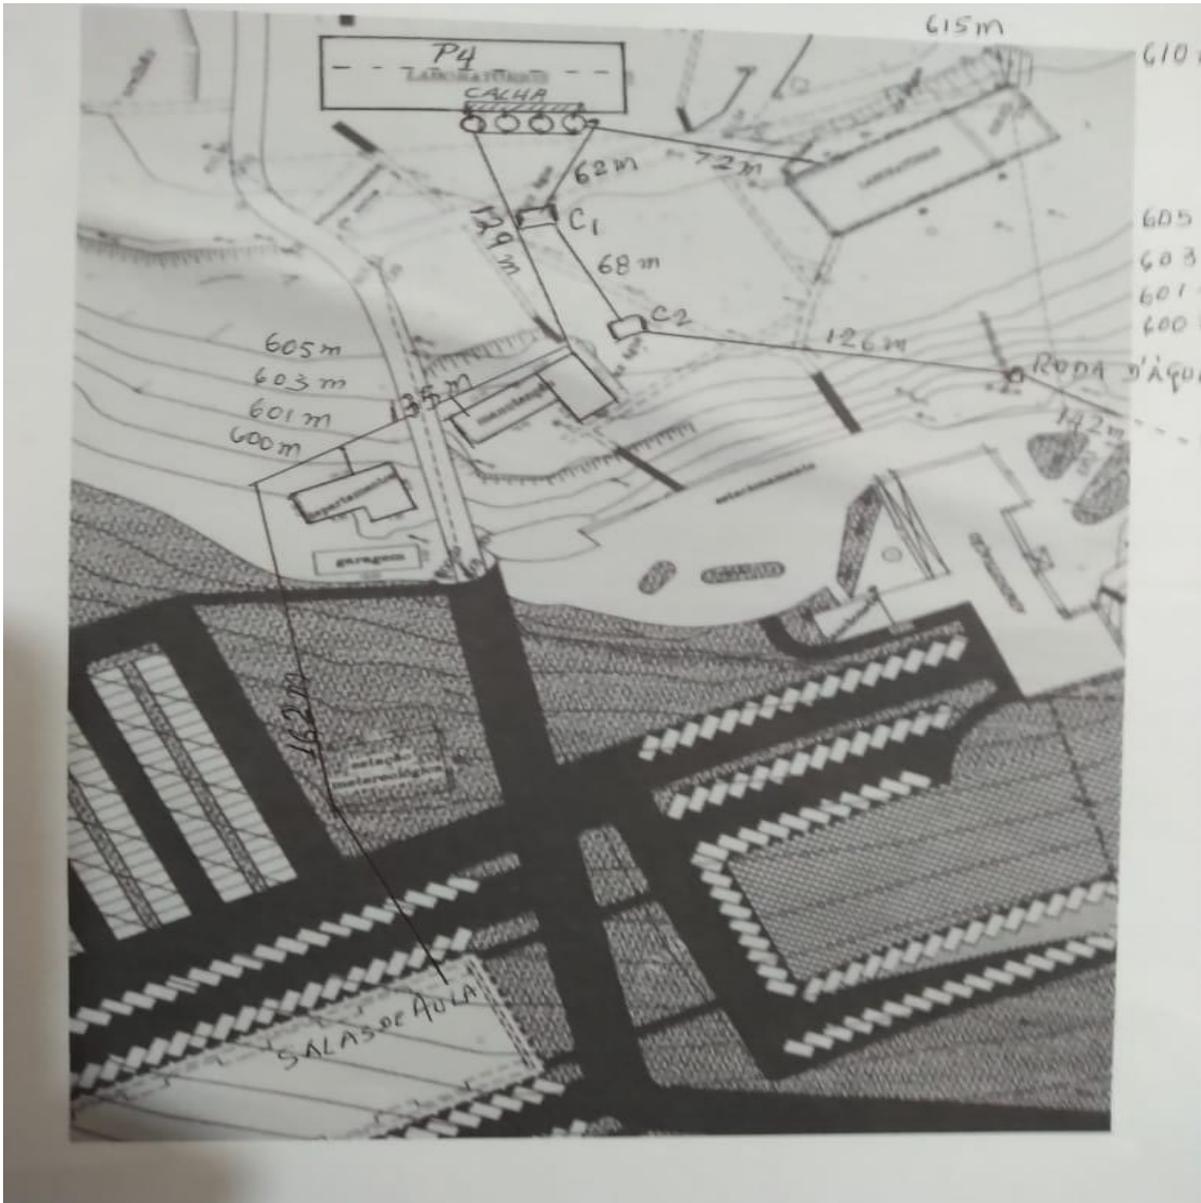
Vista em croqui demonstrando a localização por onde passarão as tubulações e localização das cisternas no Campus da Fatec-SO.
